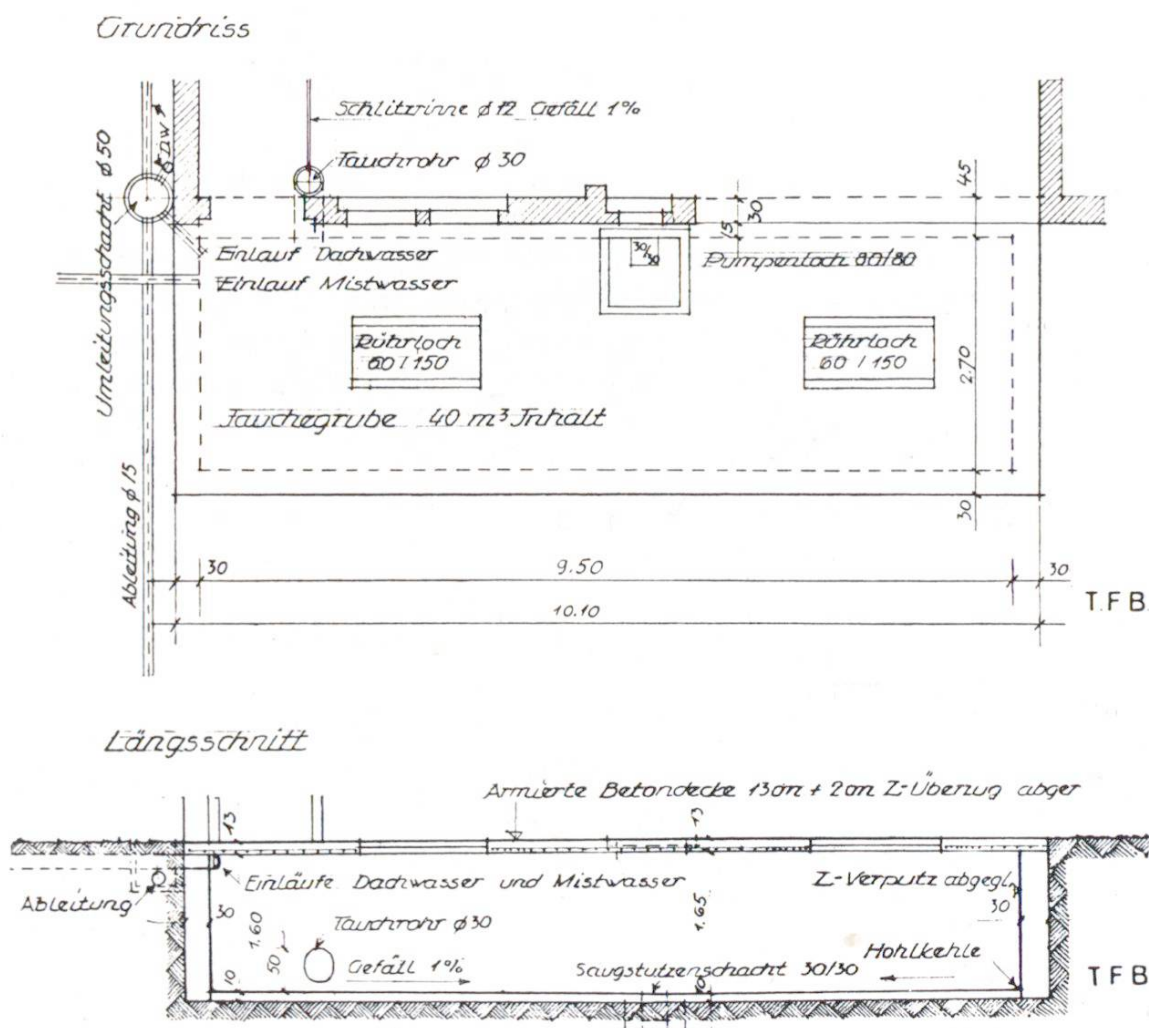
und 2 Jauchegrube von 40 m³ Inhalt, Grundriss und Längsschnitt
